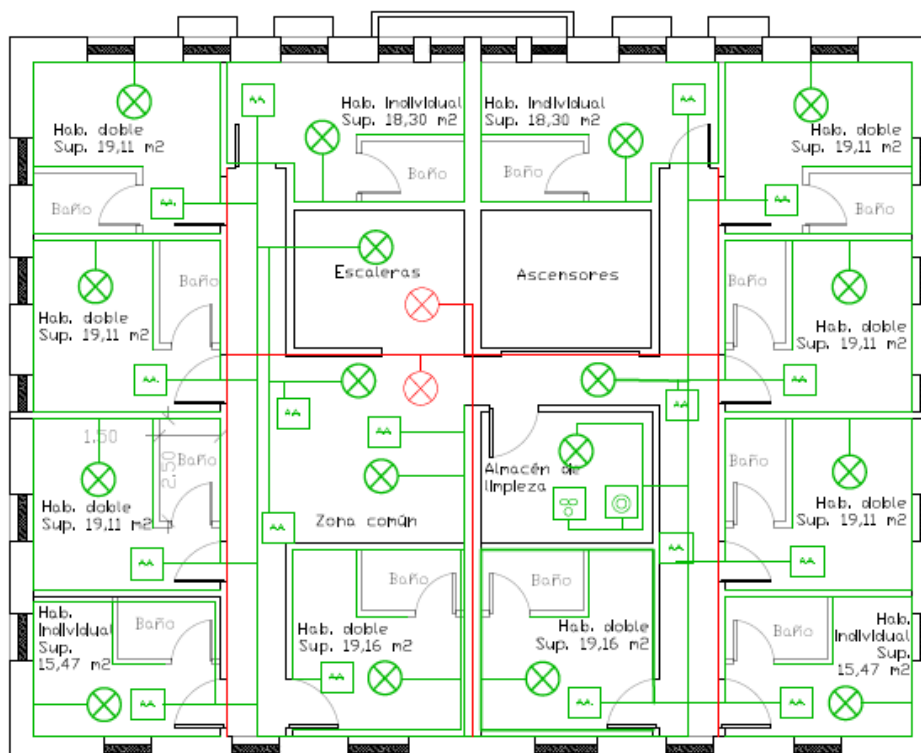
Plano del sistema eléctrico en la primera planta del edificio. Fuente: Elaboración propia
